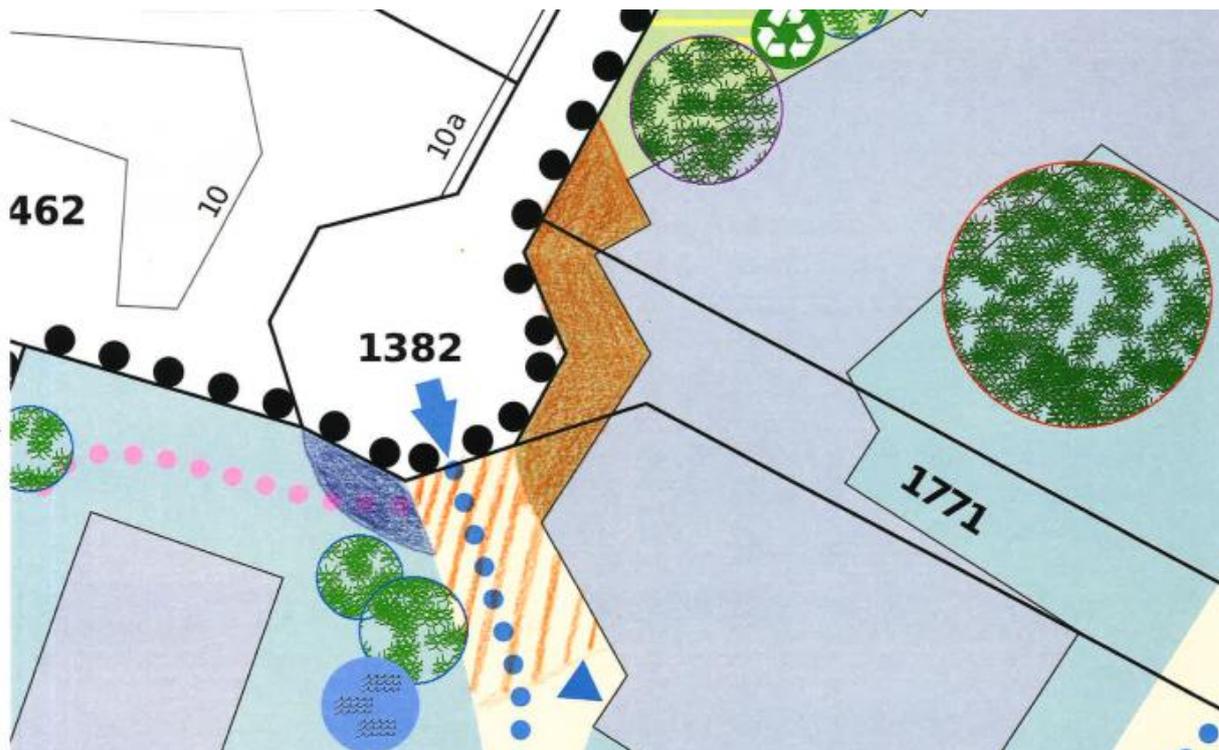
Minimalabstände (Quelle: Geoportal, 2025 mit eigener Vermessung)
